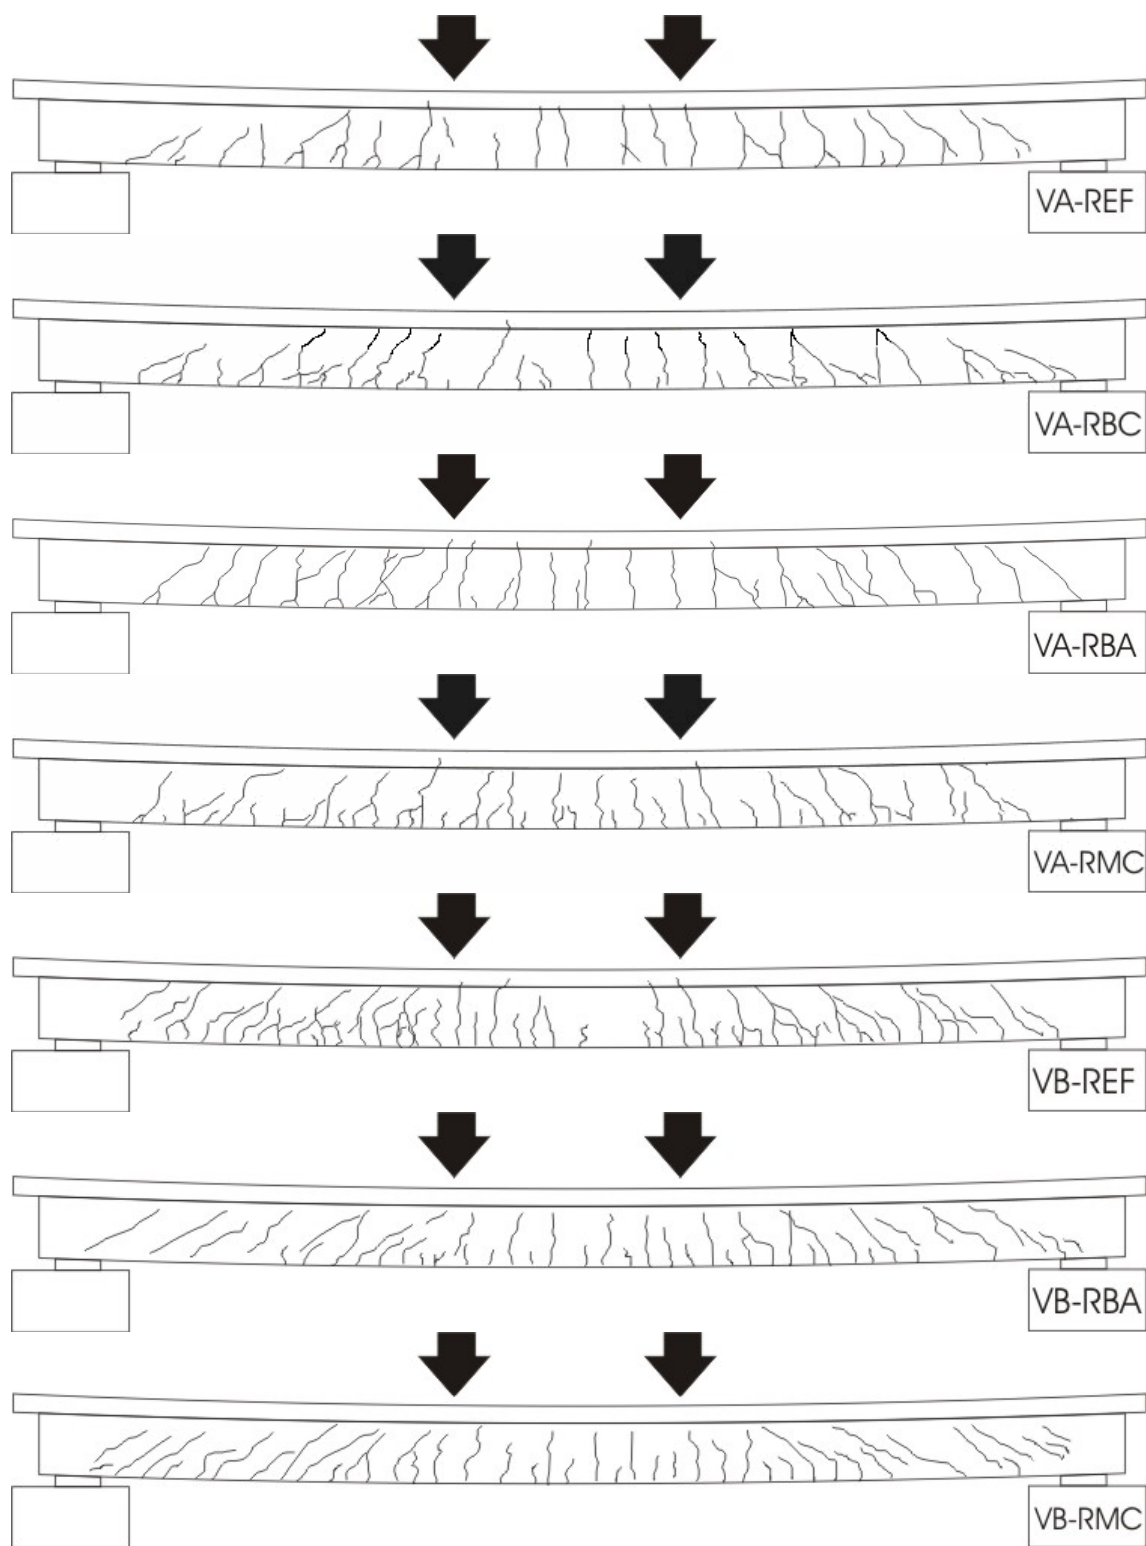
Esquema de fissuração das vigas, após o ensaio
